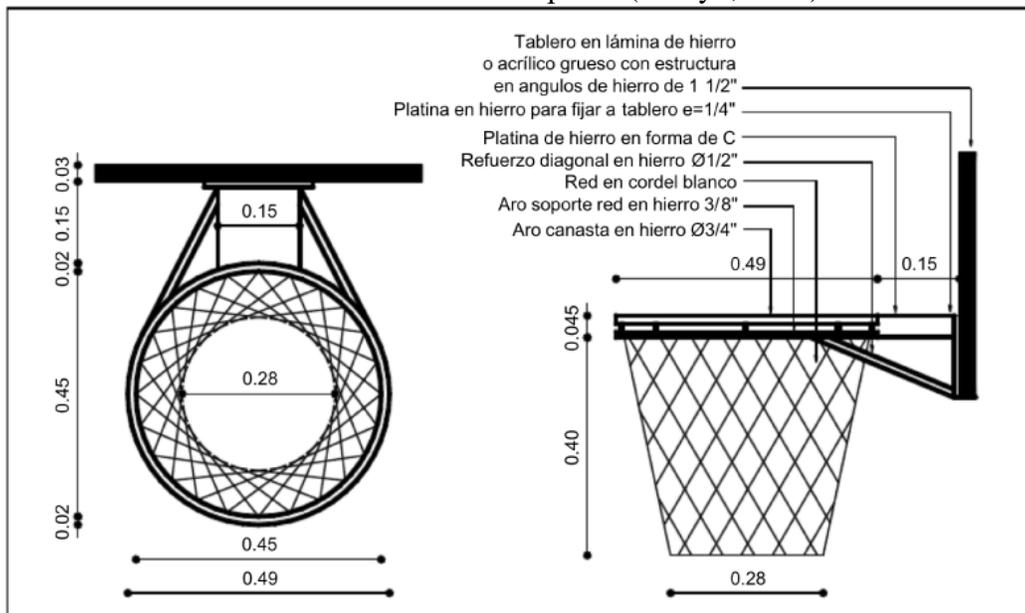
Aro del tablero – Cancha de Baloncesto - Cancha Múltiple
